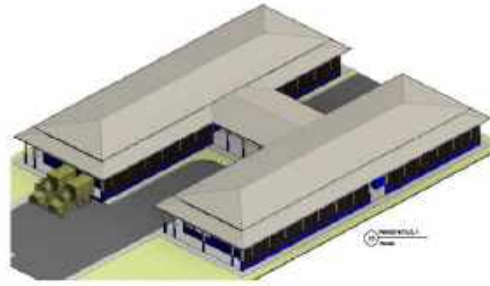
Vista da Fachada Norte/ Oeste do Pavilhão. Nota-se o uso de cobogós em toda fachada oeste, permitindo ventilação, mas anulando insolação nessa fechada. (FAUSTINO, 2018 apud RACHID, 2018).
